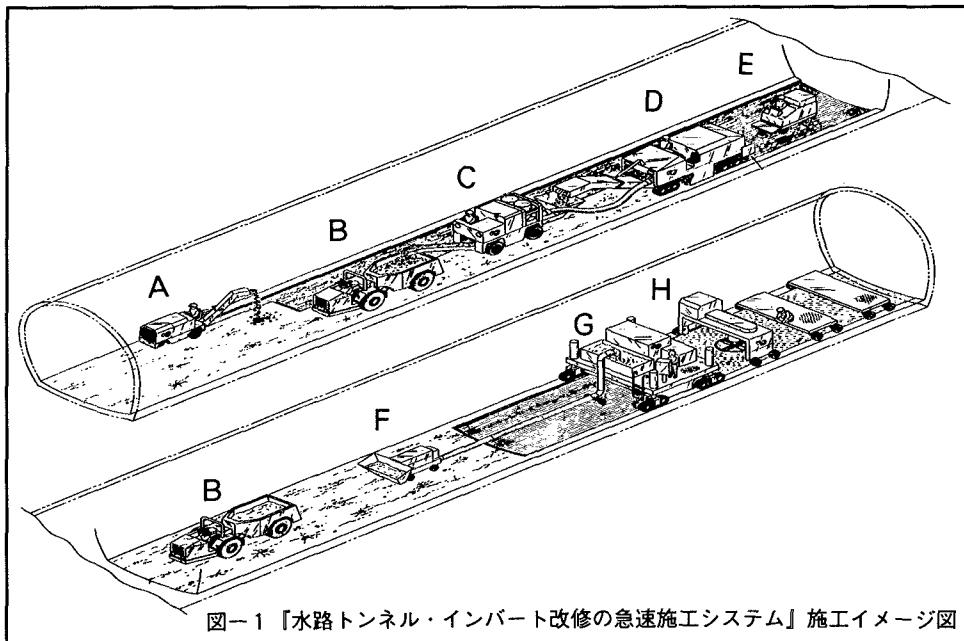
「水路トンネル・インバート改修の急速施工システム」施工イメージ図
